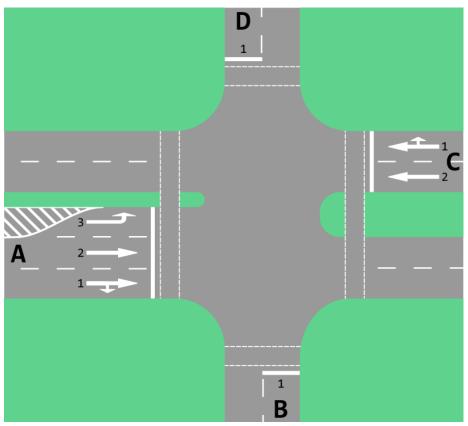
Lageplan der zu untersuchenden Kreuzung.
